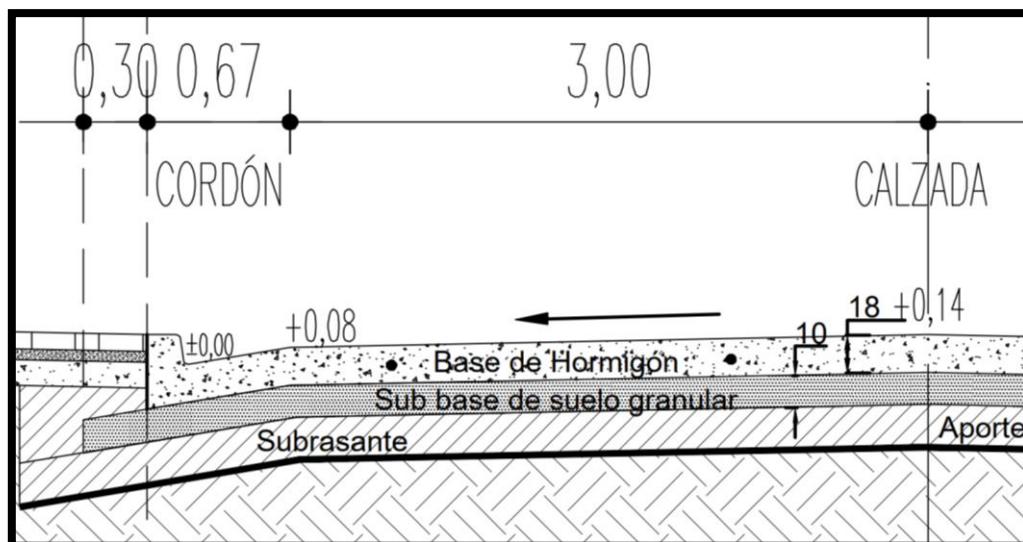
Detalle de pavimento. Fuente: Elaboración propia
